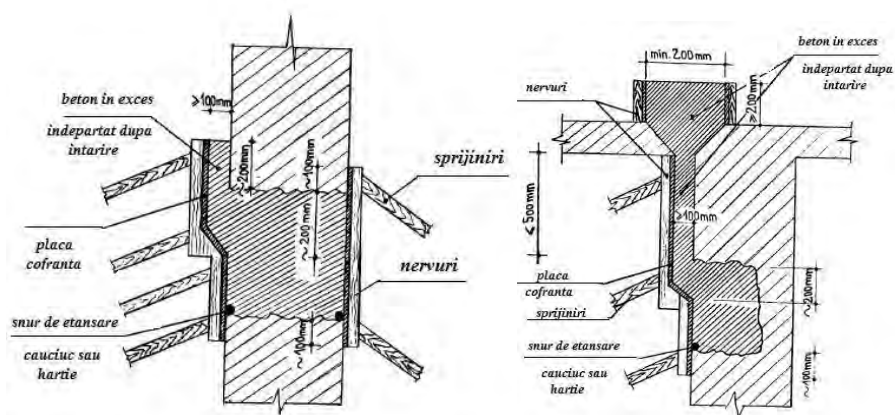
Completare golurilor cu beton pe bază de ciment [135]
